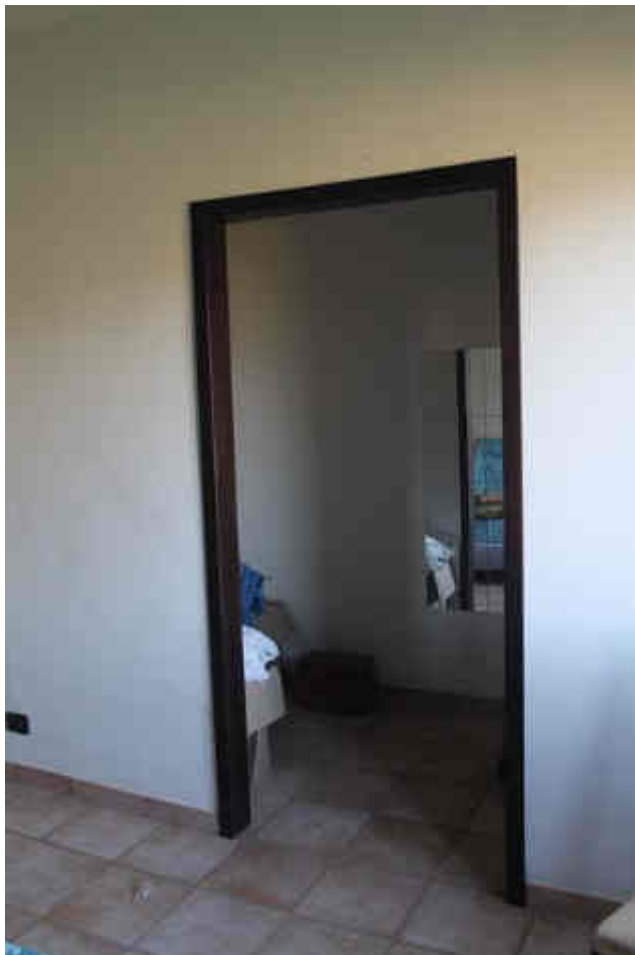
l'Armadio a muro della Camera da letto 1
